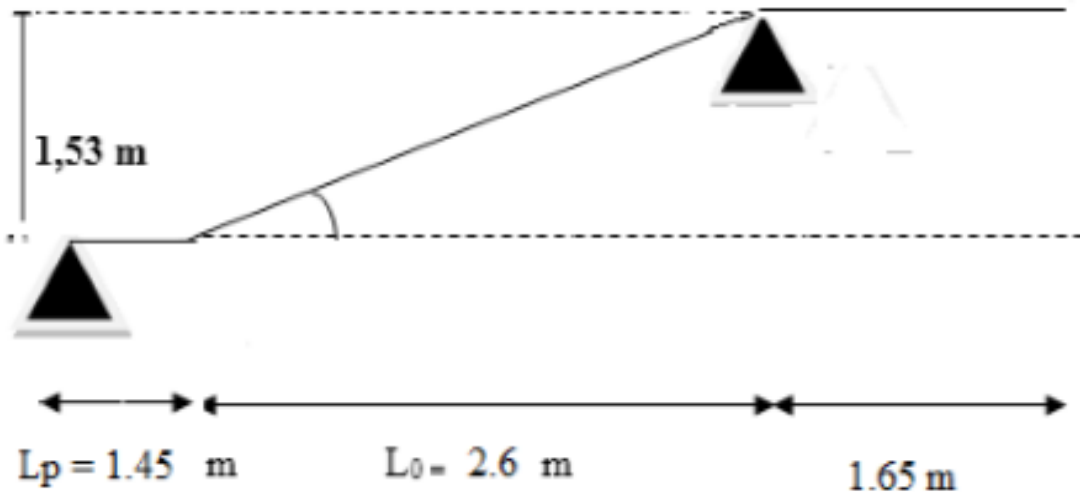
Coupe en élévation de l'escalier (étage courant)
